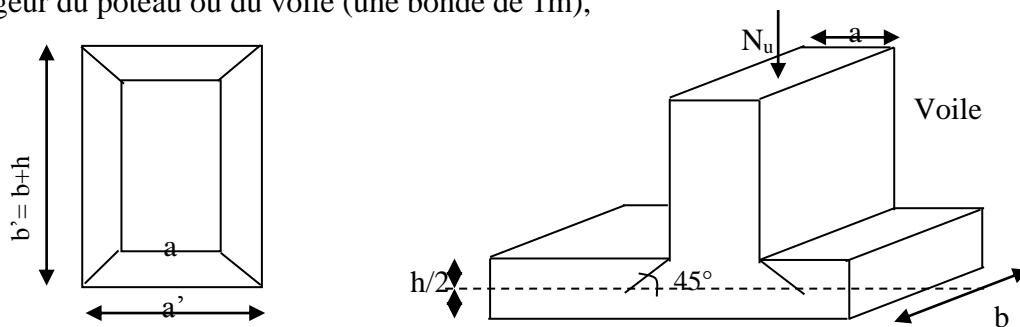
Périmètre utile des voiles et des poteaux
